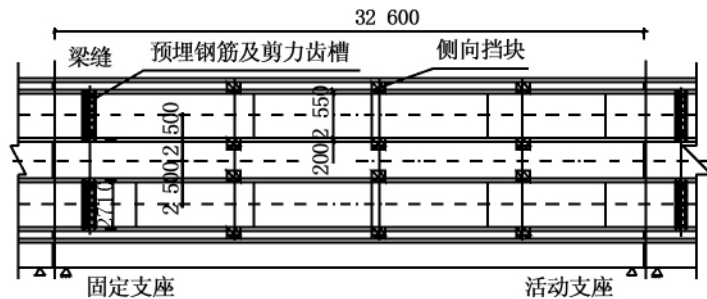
Ⅱ型板式轨道侧向挡块及剪力钢筋布置图(单位:mm)
